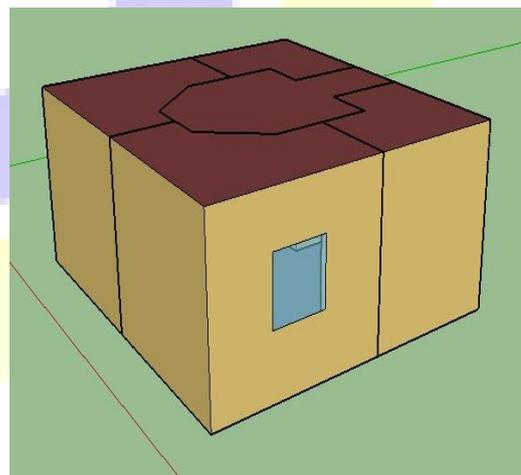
Vitrage sur la façade Est de la salle de Séjour
